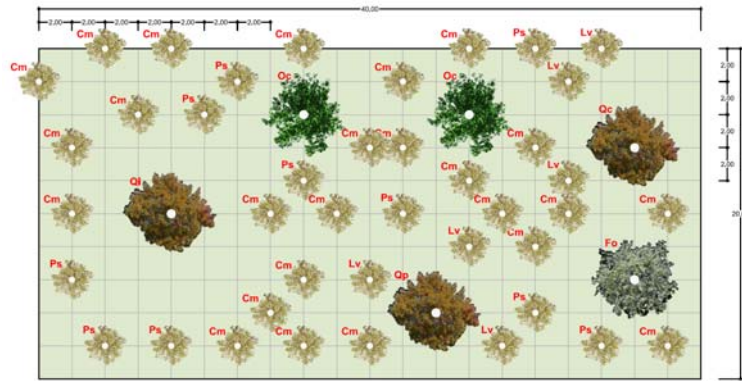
Stralcio planimetrico delle opere di mitigazione ambientale
